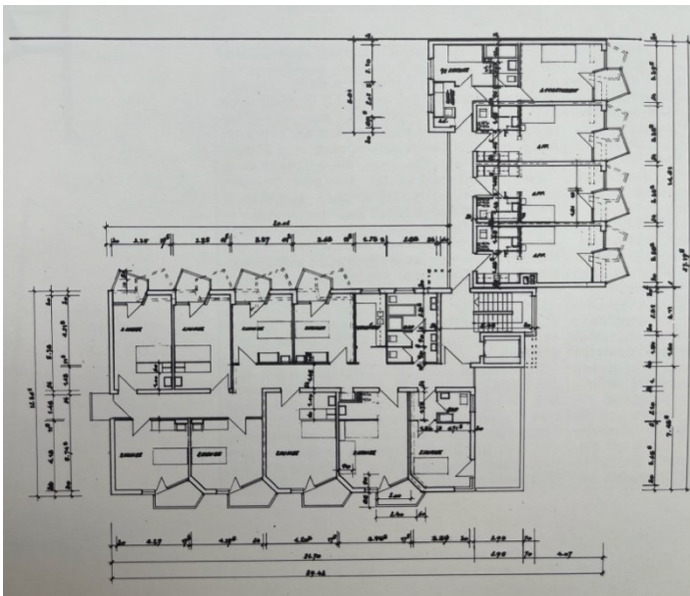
Hilde Weström, Altenheim Haus Christophorus, Grundriss 1. Obergeschoss, 1964, Berlin.
